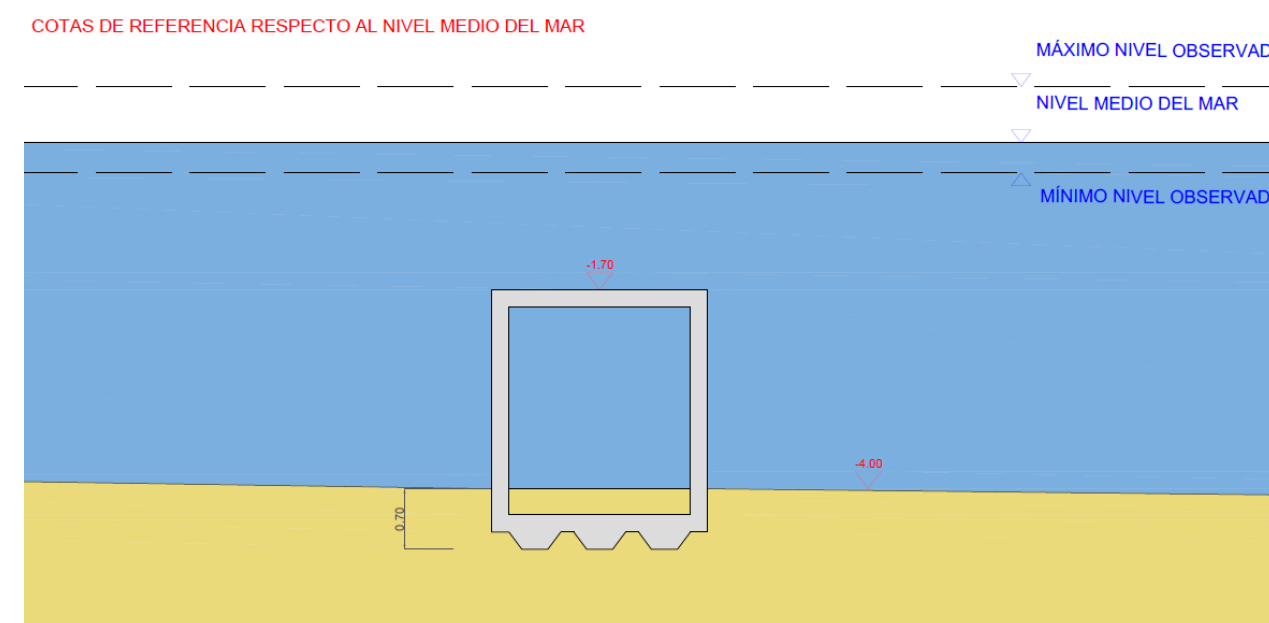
Sección transversal de la estructura asentada en el fondo. (Fuente: plano 7.1, 2023)
